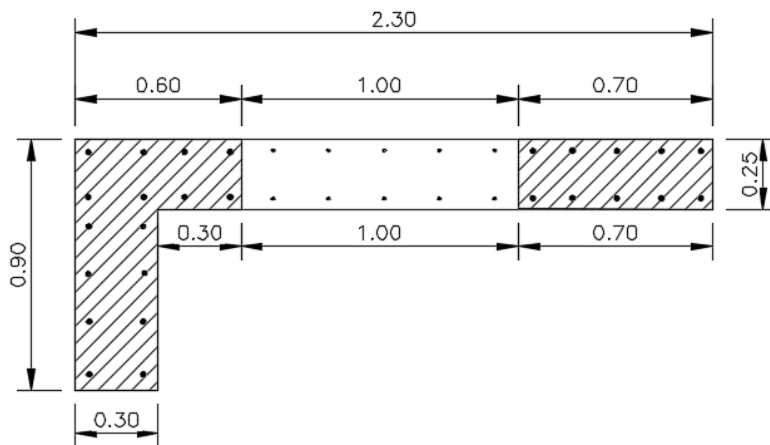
Dimensiones y armadura en los núcleos en la placa PL-2
